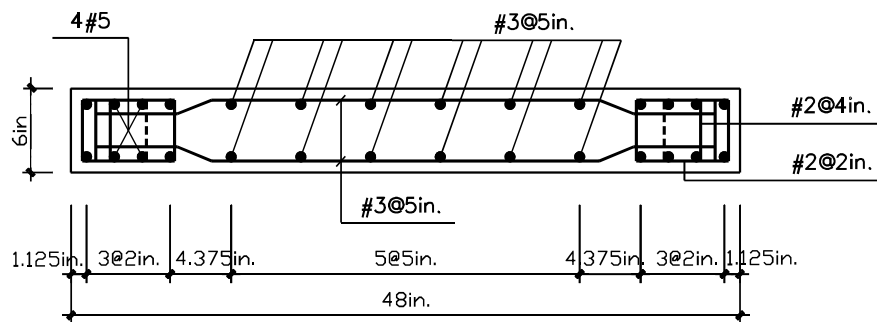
Detallado y refuerzo del espécimen RW-A15-P10-S78 (Tran & Wallace, 2012)
